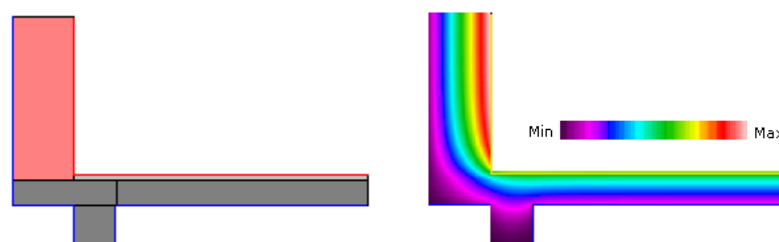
Detaliu intersecție perete exterior cu planșeu exterior inferior peste subsol (Pl. 4.2/ Pl. 4.3)
